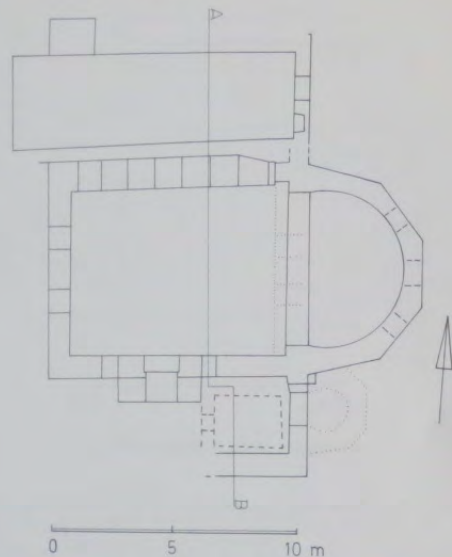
Kirche 21, Grundriß. A-B Lage des Querschnitts in Abb. 37. M 1:200
